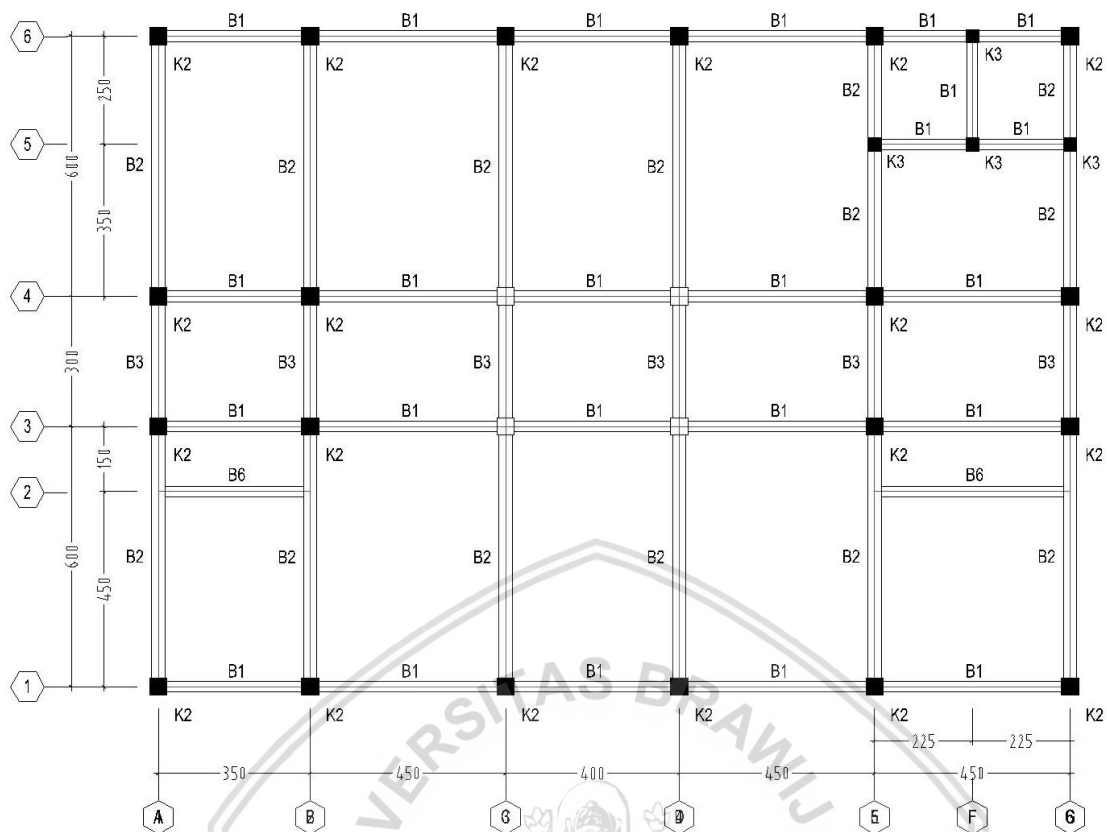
Pemodelan Denah Balok-Kolom Lantai Mezanin (Level 1)
